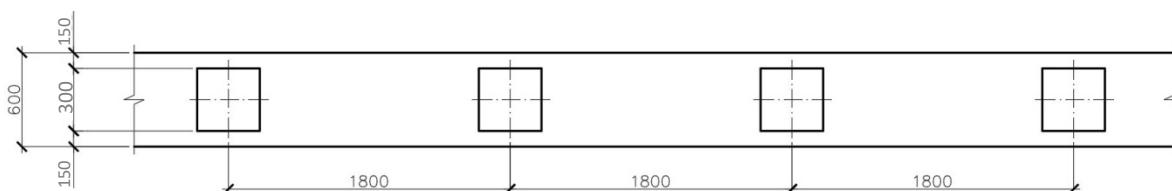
схема расположения свай в рядовом фундаменте
